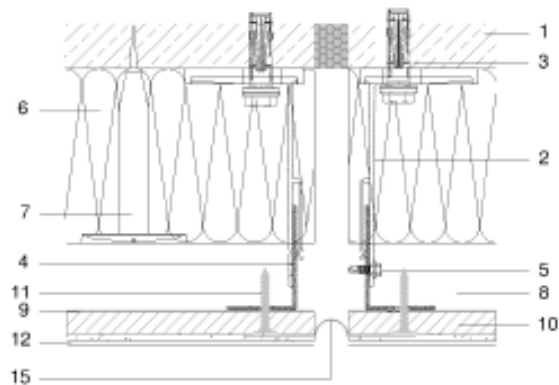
Detalhe construtivo em corte de junta de dilatação do edifício [78].
